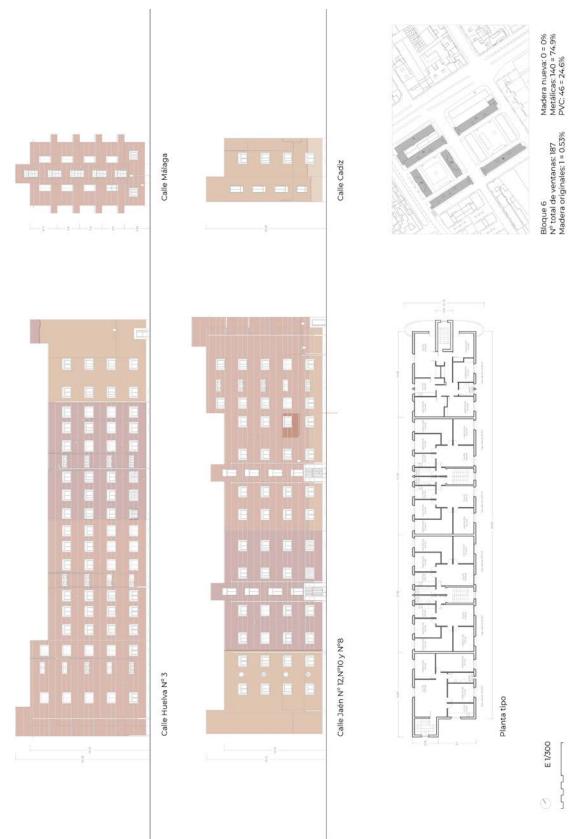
c.23. Planimetría del BLOQUE 6. Obra del Hogar Nacional Sindicalista
